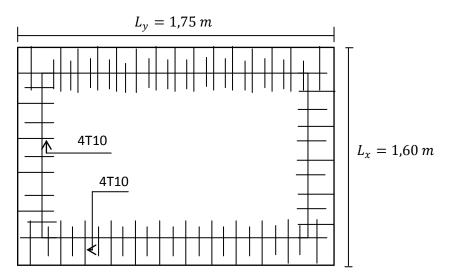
Ferraillage supérieur de la dalle de l'ascenseur.
